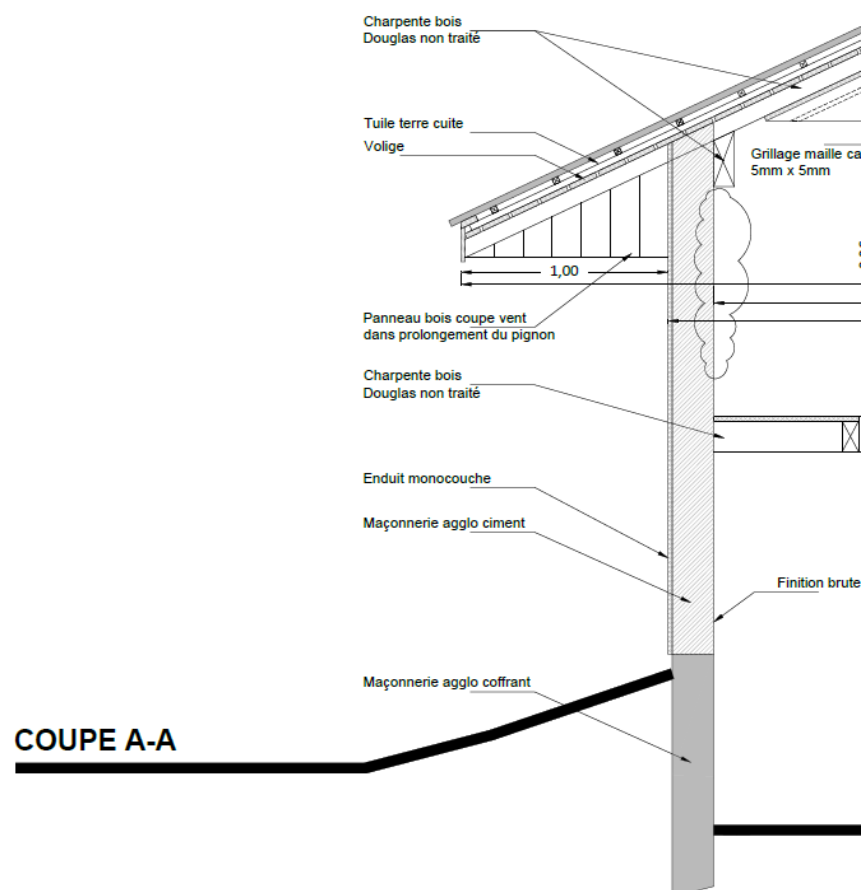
Plan des panneaux coupe-vent dans le prolongement de chaque pignon
